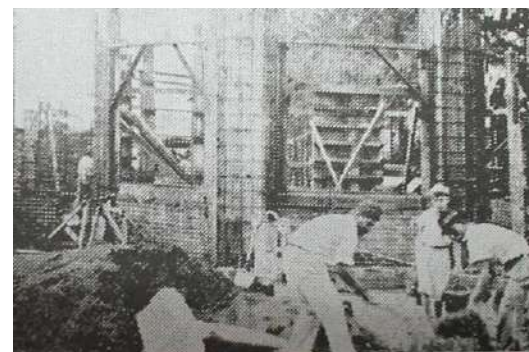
construcción de la Unidad Sanitaria, detalle de la armadura de la cubierta y paredes del vestíbulo, año 1937
